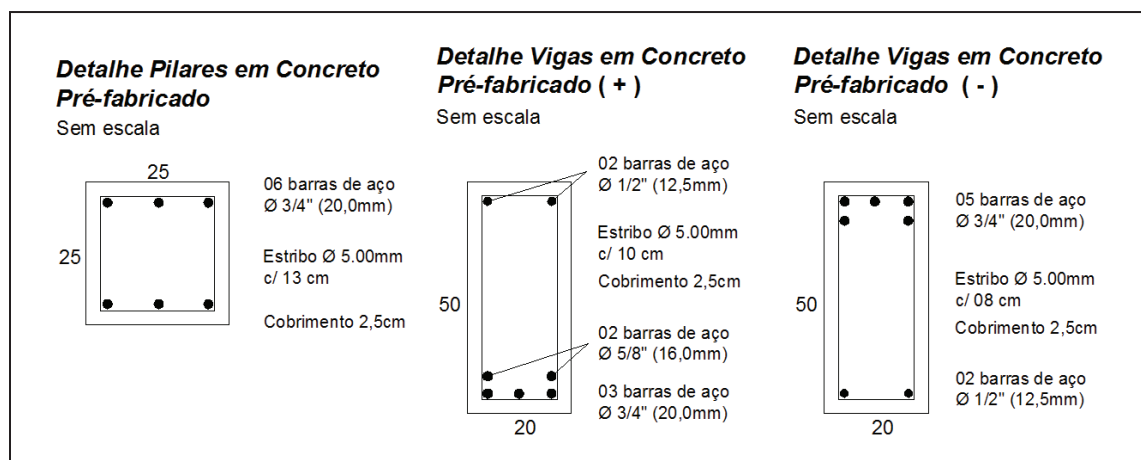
Detalhe seção vigas e pilares - análise 06 pavimentos.
